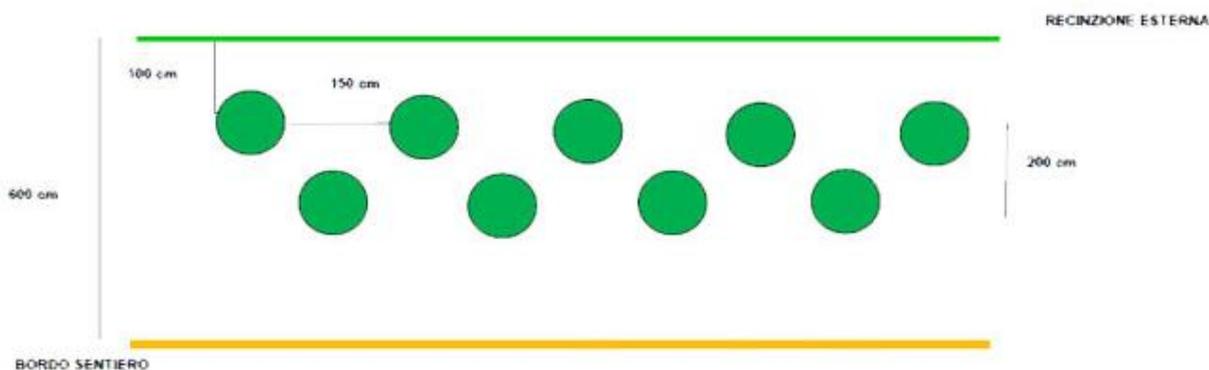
Fasci arbustiva/arborea mista a doppia fila sfalsata (planimetria di progetto).
